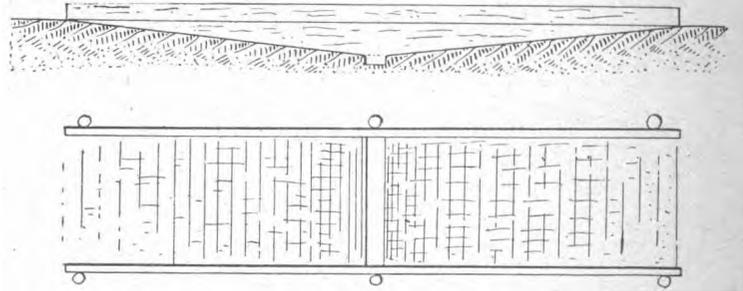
Plate-forme à fumier concave avec rigole centrale. (Vue en coupe et en plan.)
